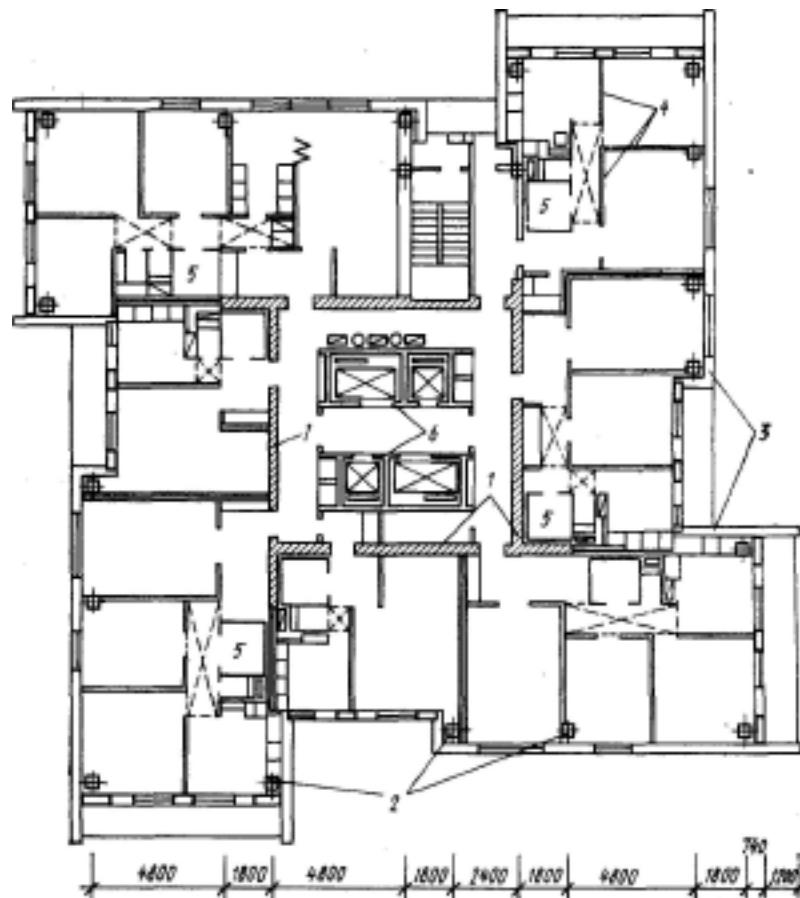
Каркасно-панельный 25-этажный жилой дом с монолитным ядром жесткости: План типового этажа:
